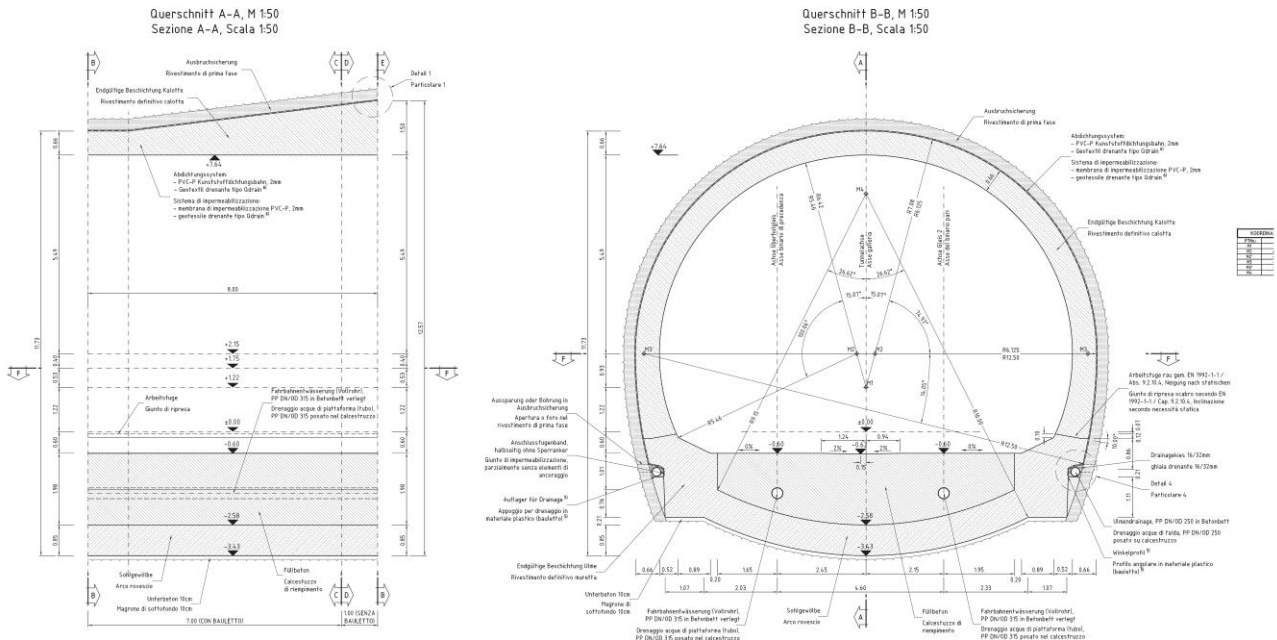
Carpenteria sezione tipo S2-DR-4.6-C1trans – classe di avanzamento C1.
